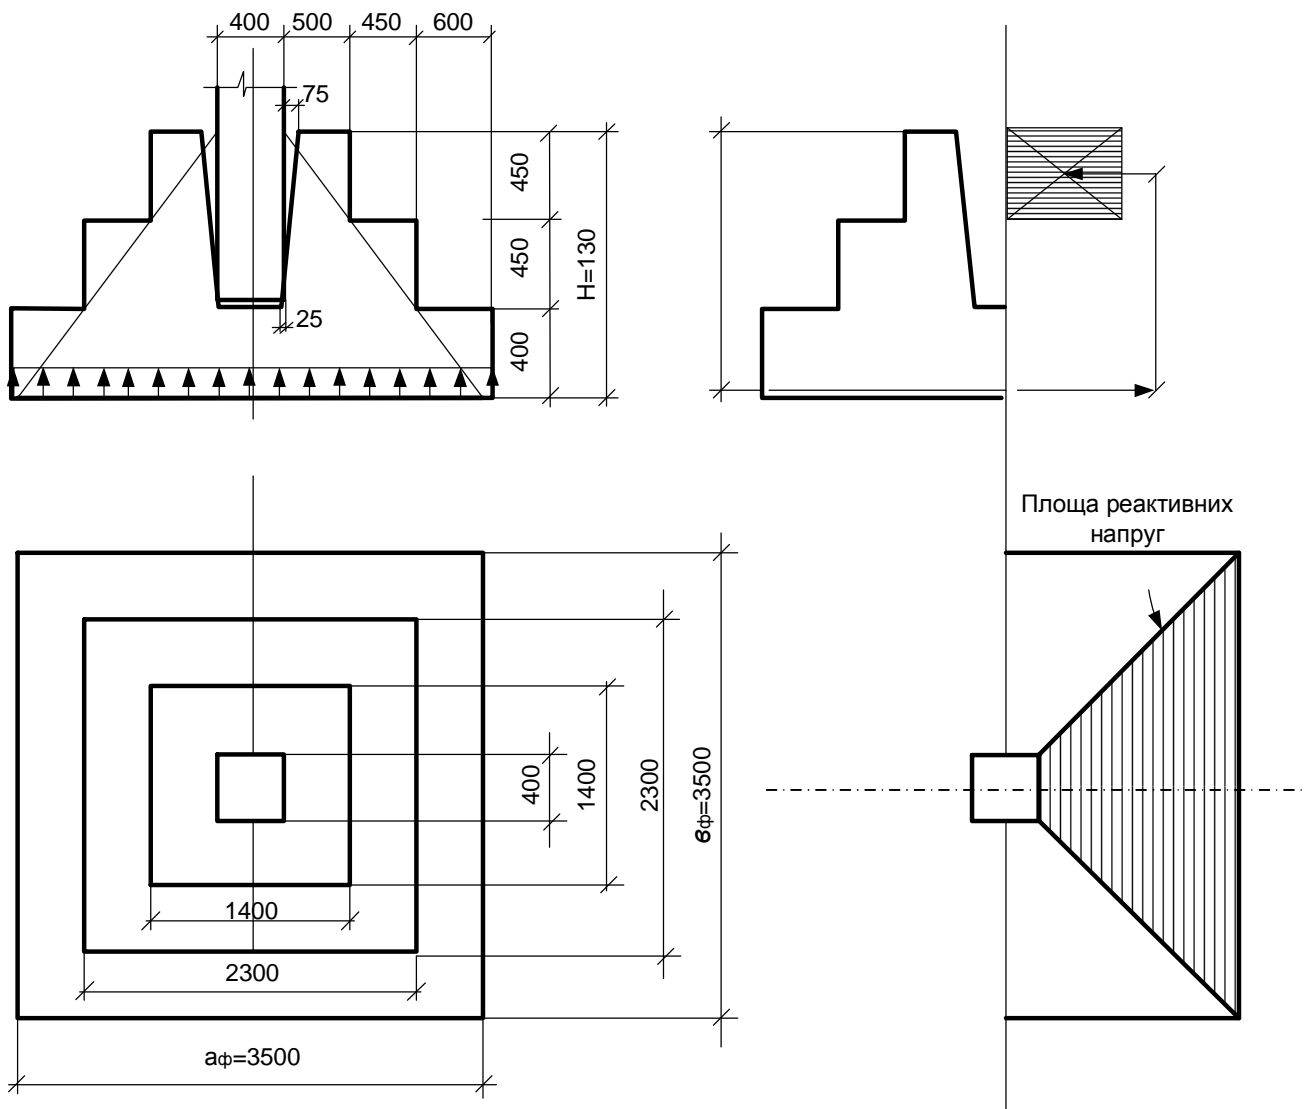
Розрахункова схема центрально навантаженого фундаменту
